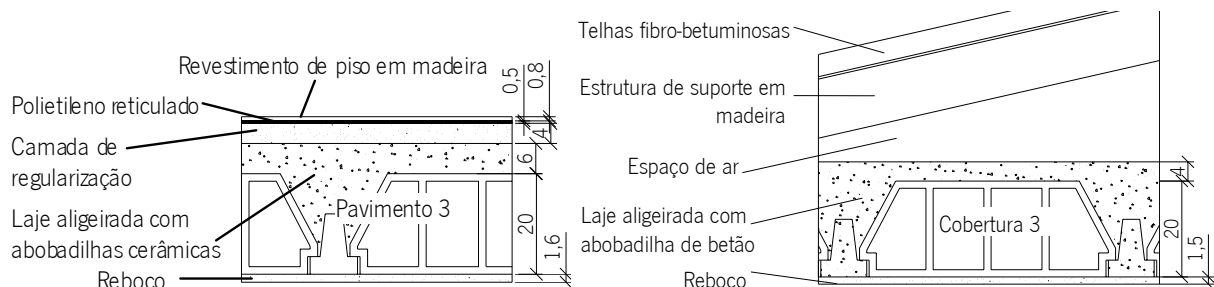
Corte esquemático das soluções construtivas Convencionais das coberturas e dos pavimentos
